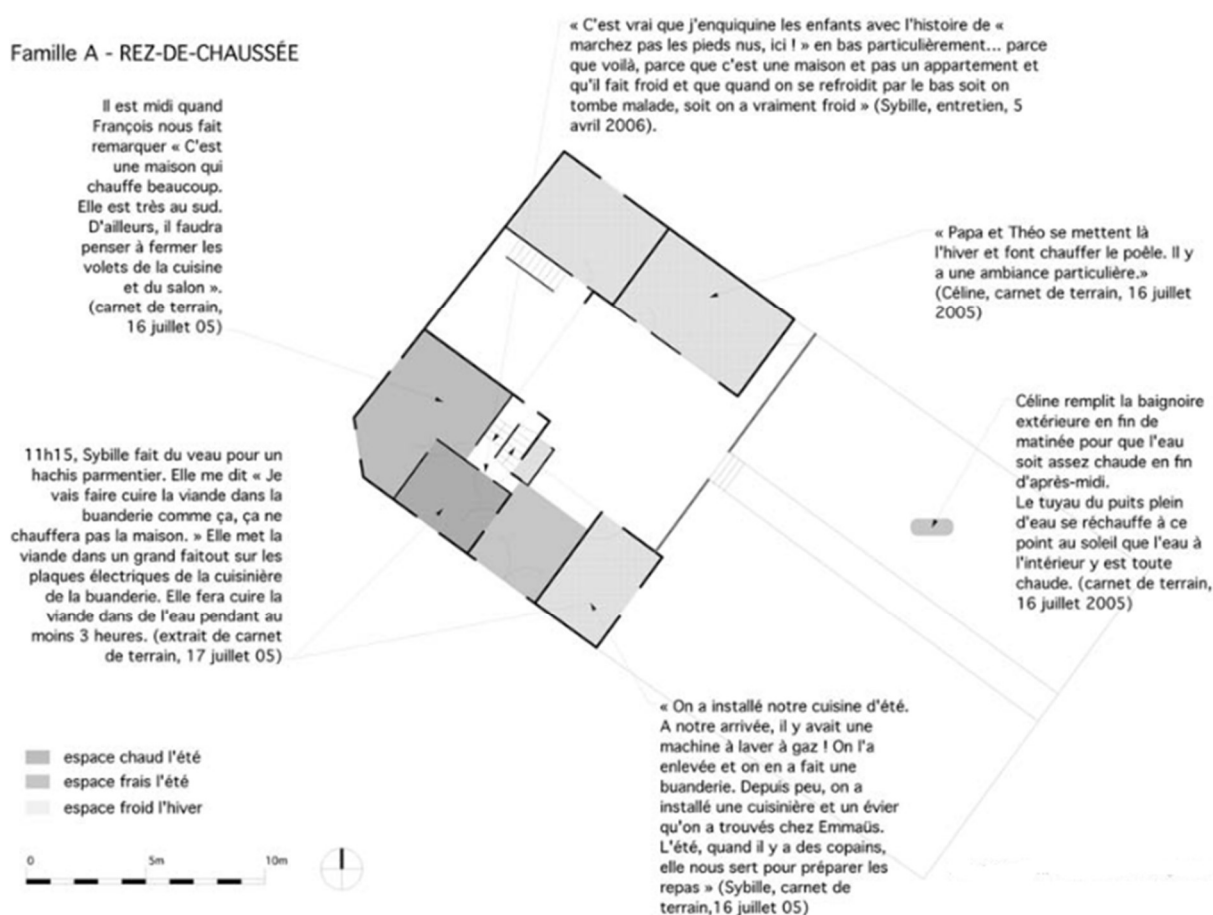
Exemple de plan saisonnier d'une famille (Subrémon, 2010)
